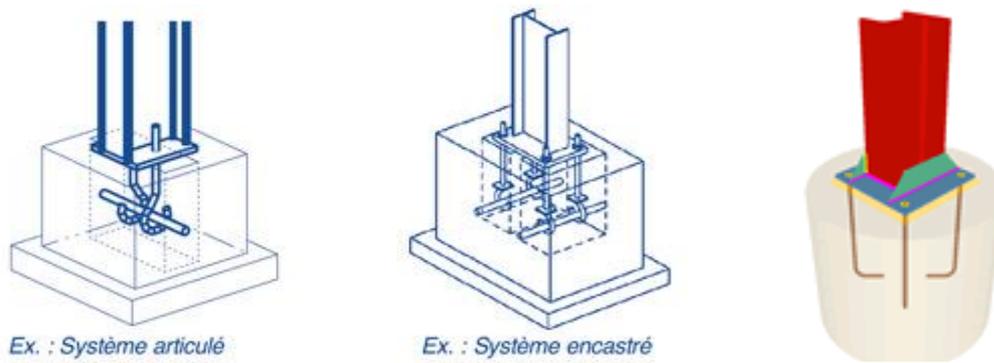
Exemple de poteau métallique avec fondation en béton armé
